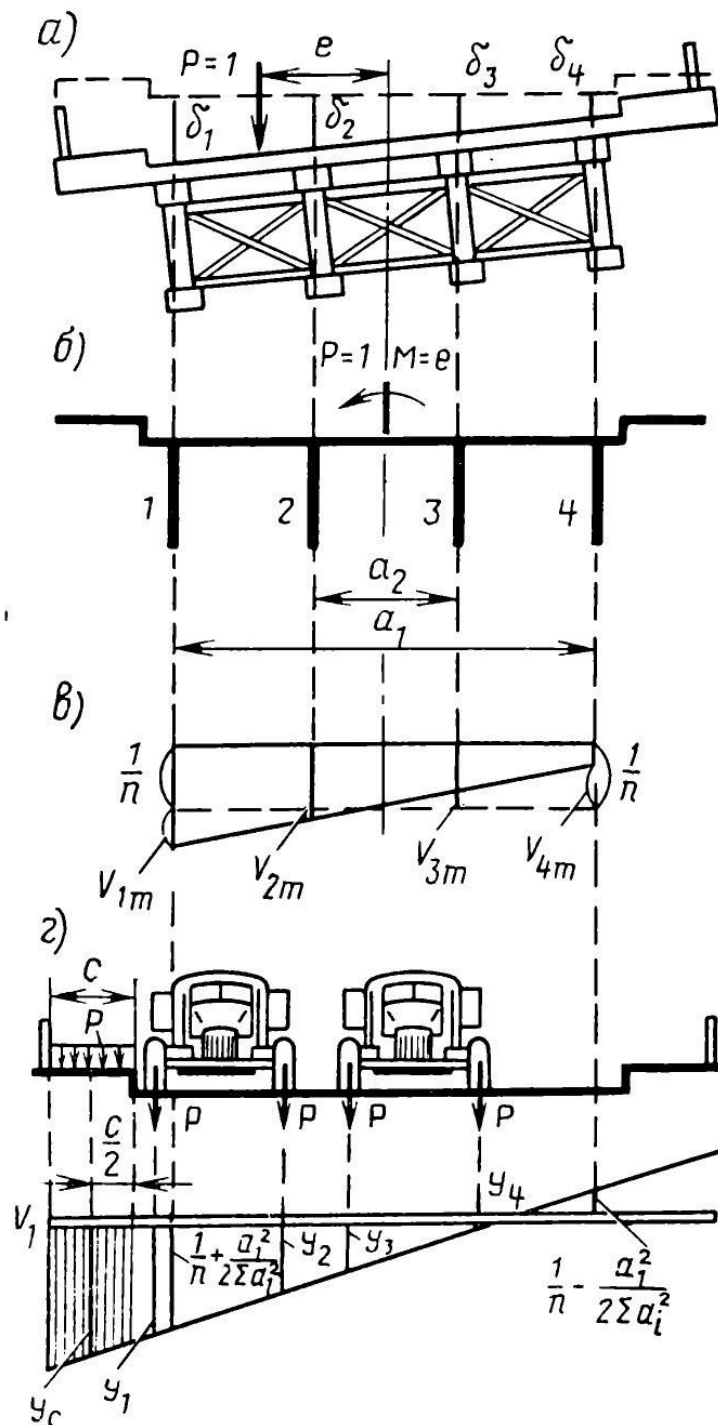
Схемы к определению коэффициента поперечной установки для пролетного строения с ездой поверху и жесткими поперечными связями
